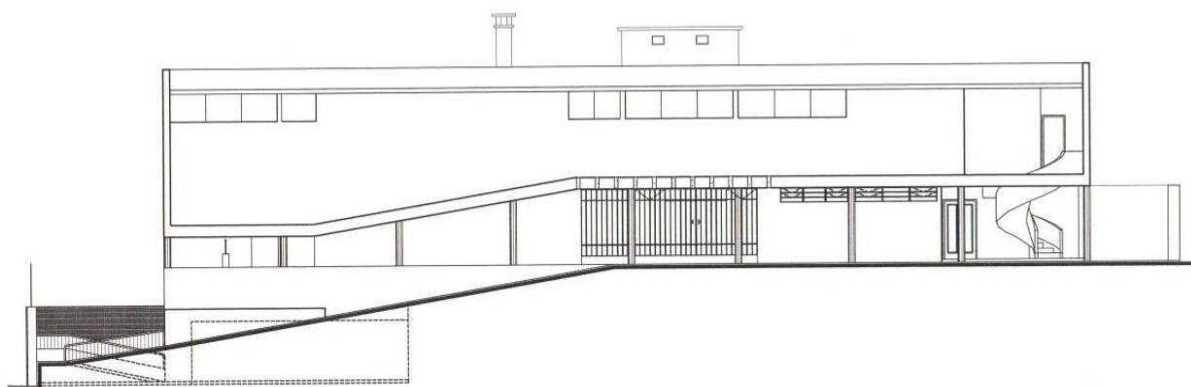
ELEVAÇÃO LATERAL DIREITA , FACHADA SSE
